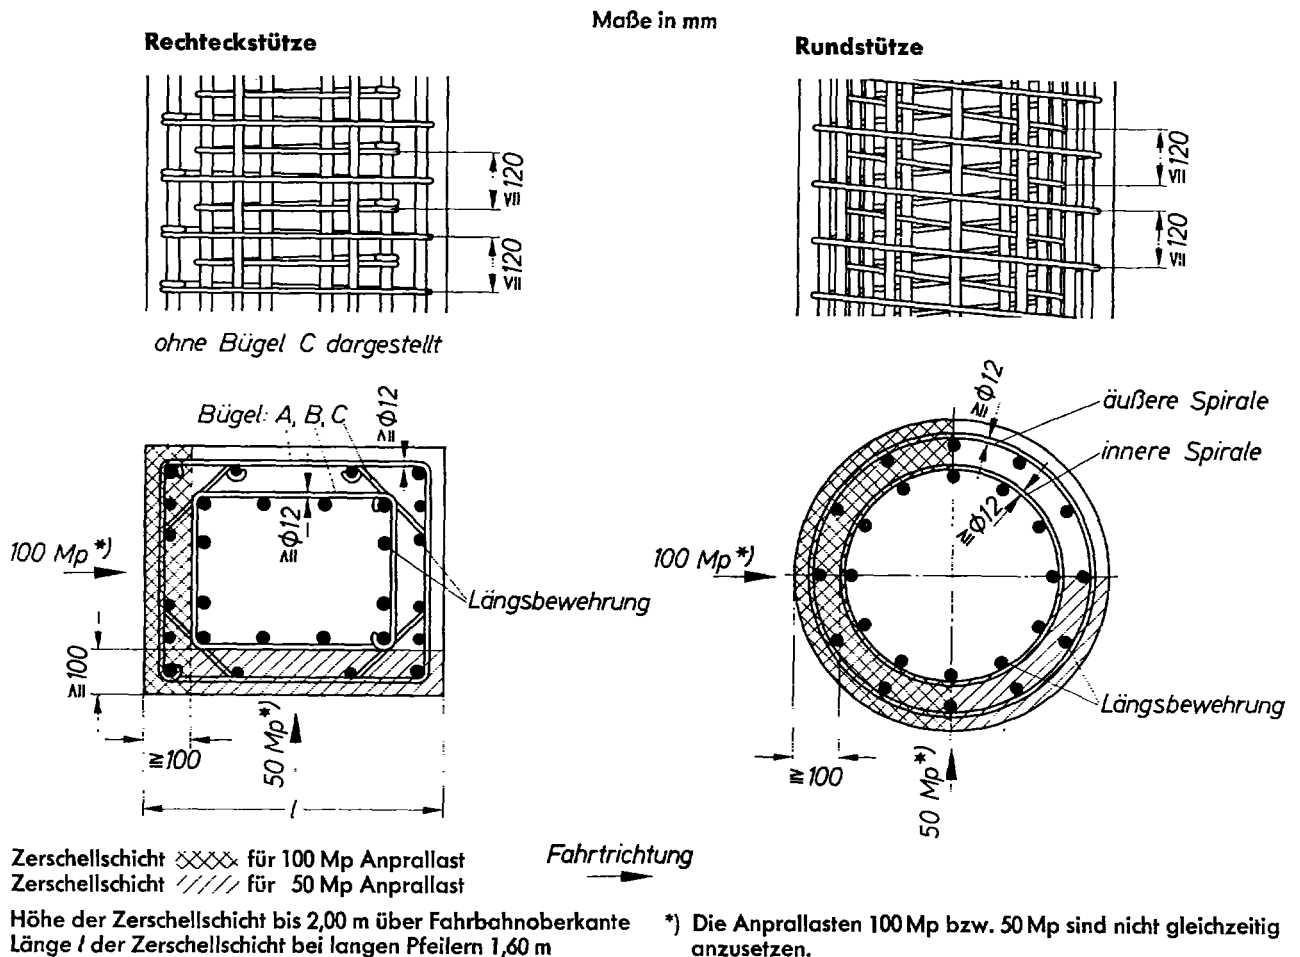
Bewehrung anprallgefährdeter Stahlbetonstützen
